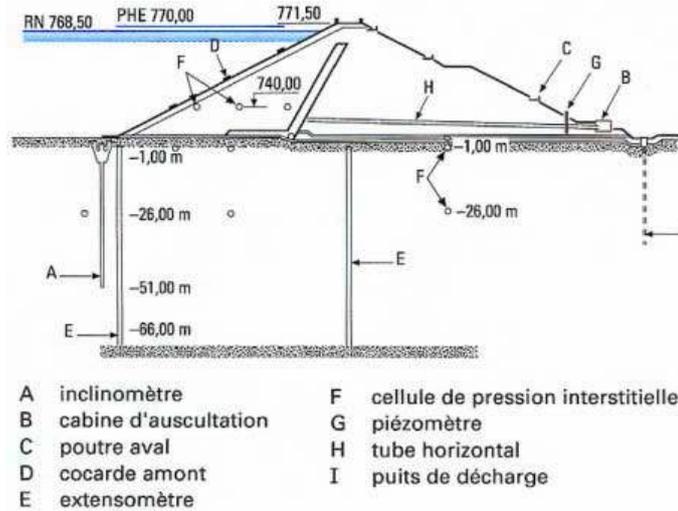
Barrage à masque bitumineux du Verney (France)
